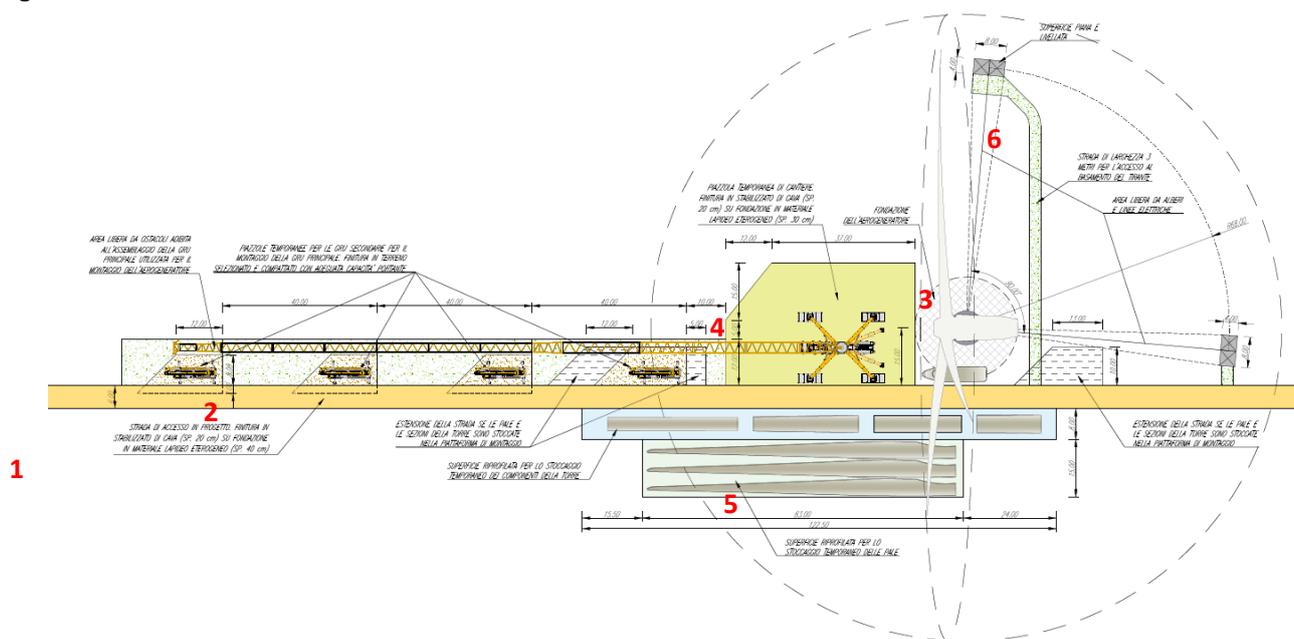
Piazzola di montaggio; 1. Strada di accesso; 2. Blocchi ausiliari; 3. Area di assemblaggio della torre; 4. Area di lavoro gru principale; 5. Area di stoccaggio; 6. Blocchi di ancoraggio - controvento.
